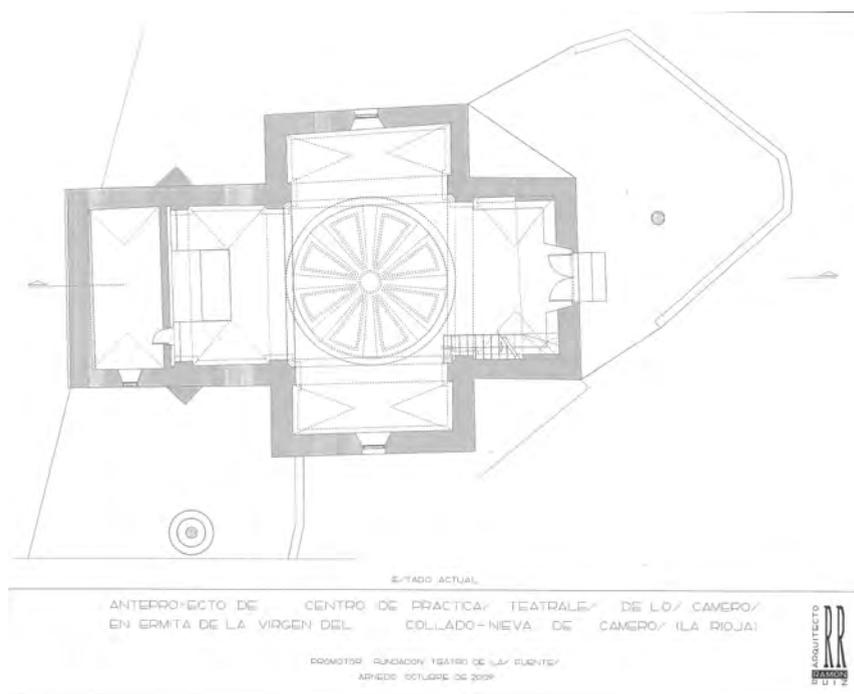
Planta de la ermita de Nuestra Señora del Collado. Arquitecto Ramón Ruiz
